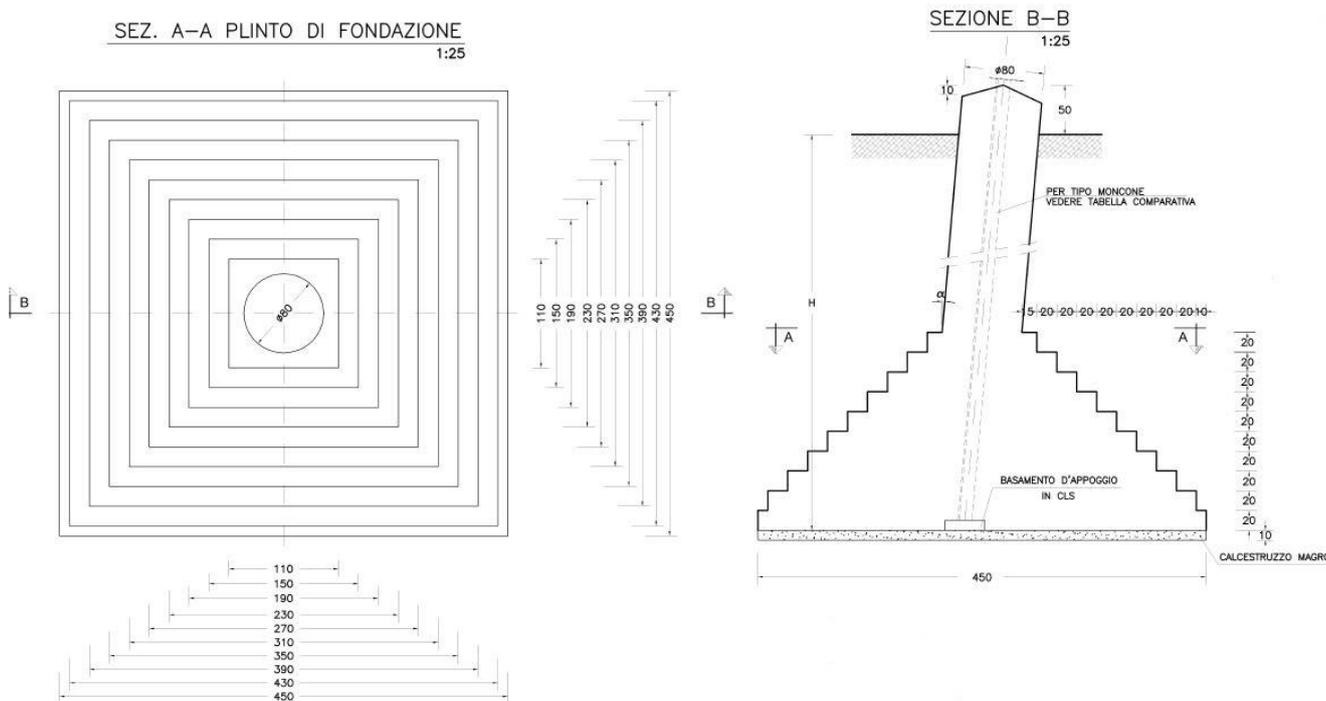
Fondazione a plinto con riseghe tipo per palo di amarro doppia terna
